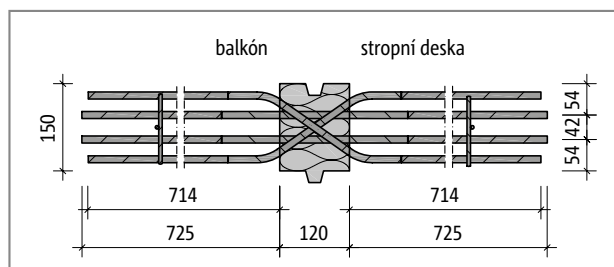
Schöck Isokorb® typ EQXT1: Řez prvkem
